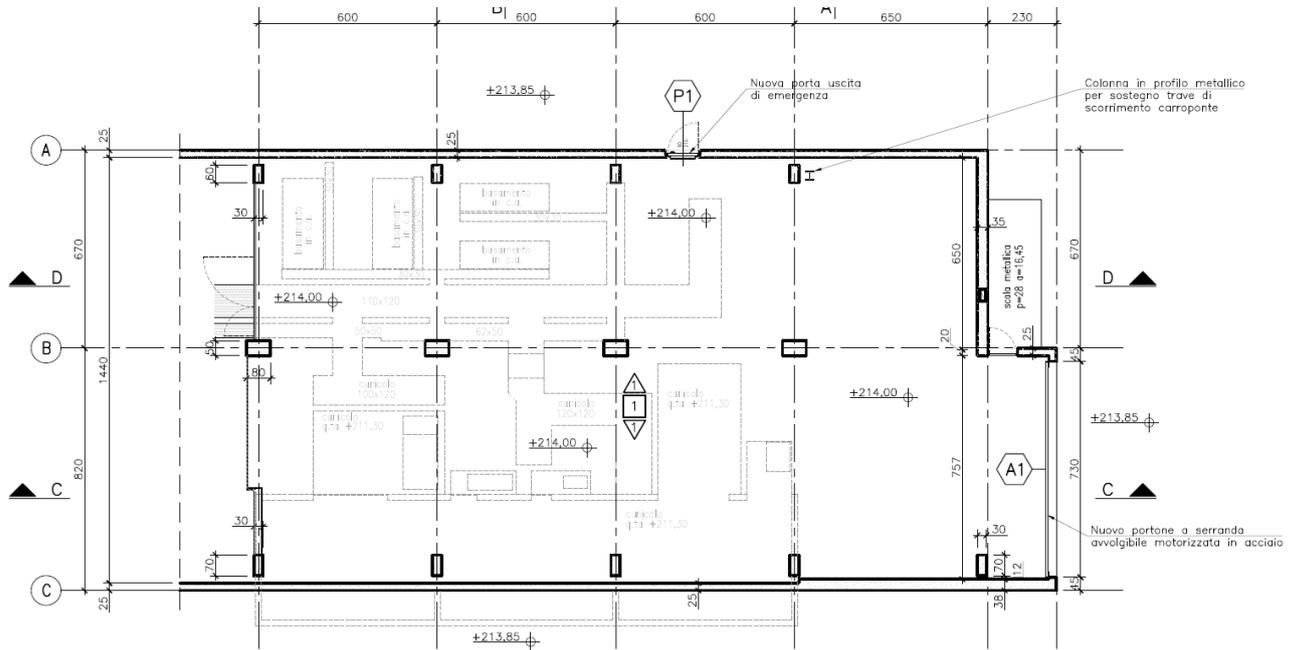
Pianta dell'edificio 21n - Post Operam
